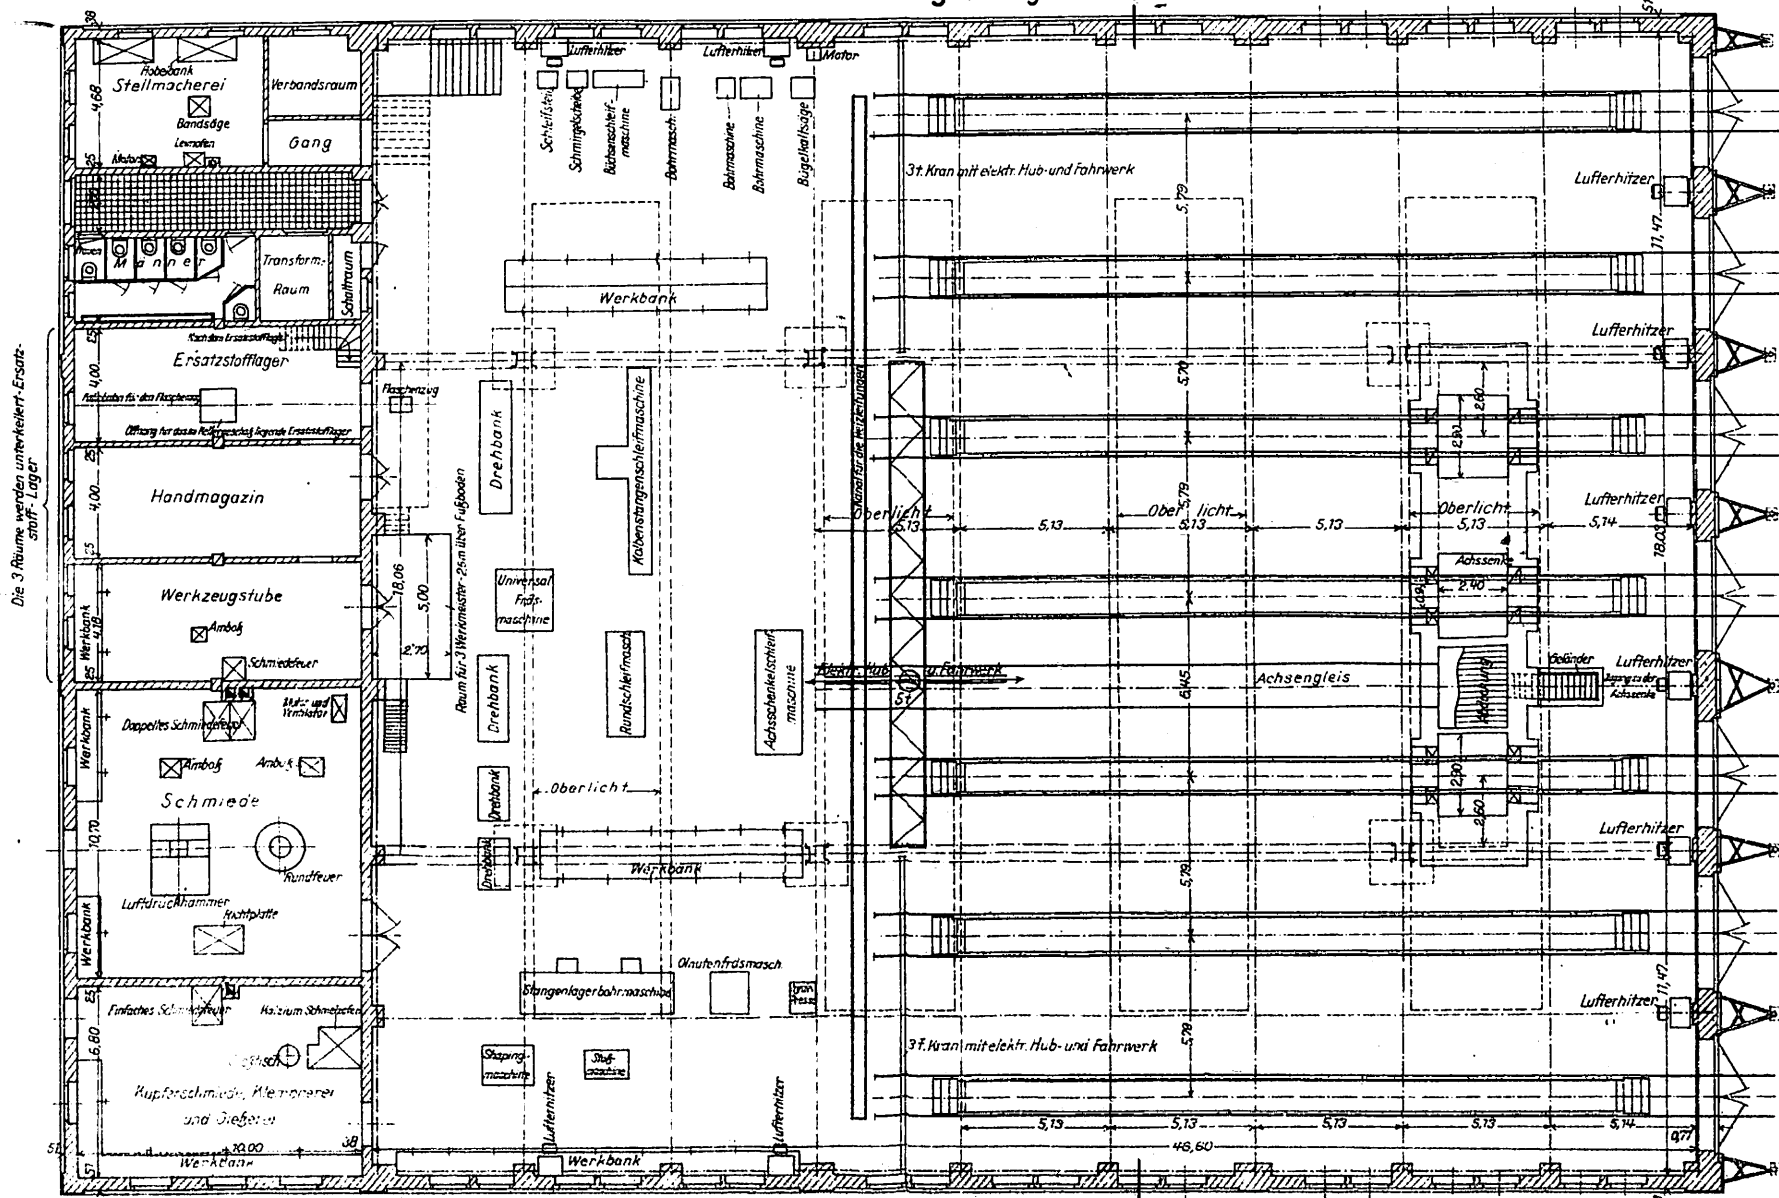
Lageplan des Bahnbetriebswerkes Dresden-Altstadt
